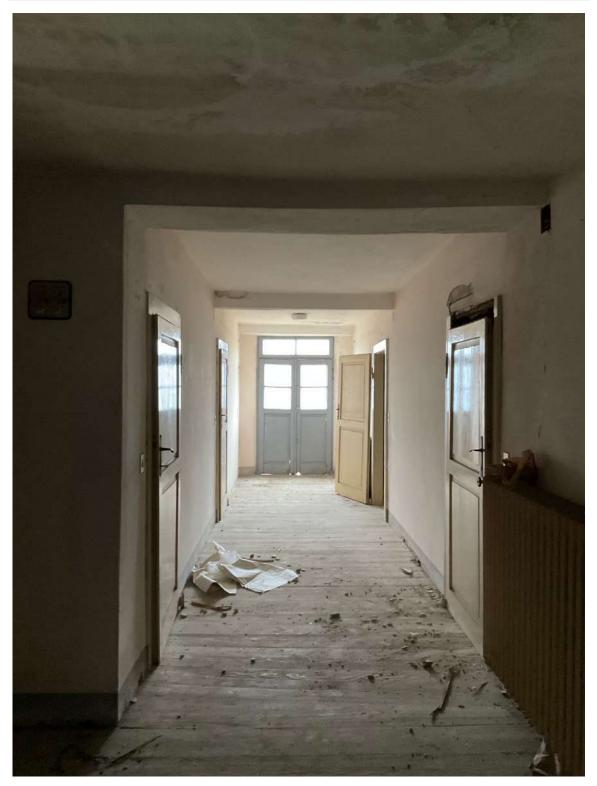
| Secondo Piano: il corridoio che disimpegna le camere d'albergo.
